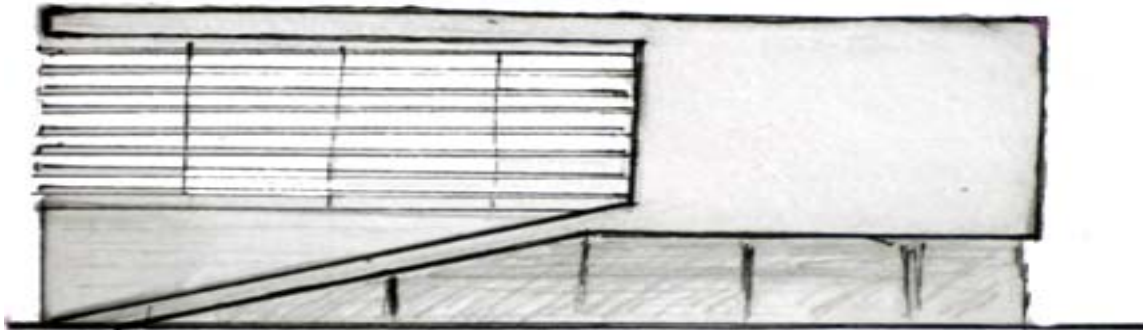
Primer boceto de propuesta para fachada principal (este).
